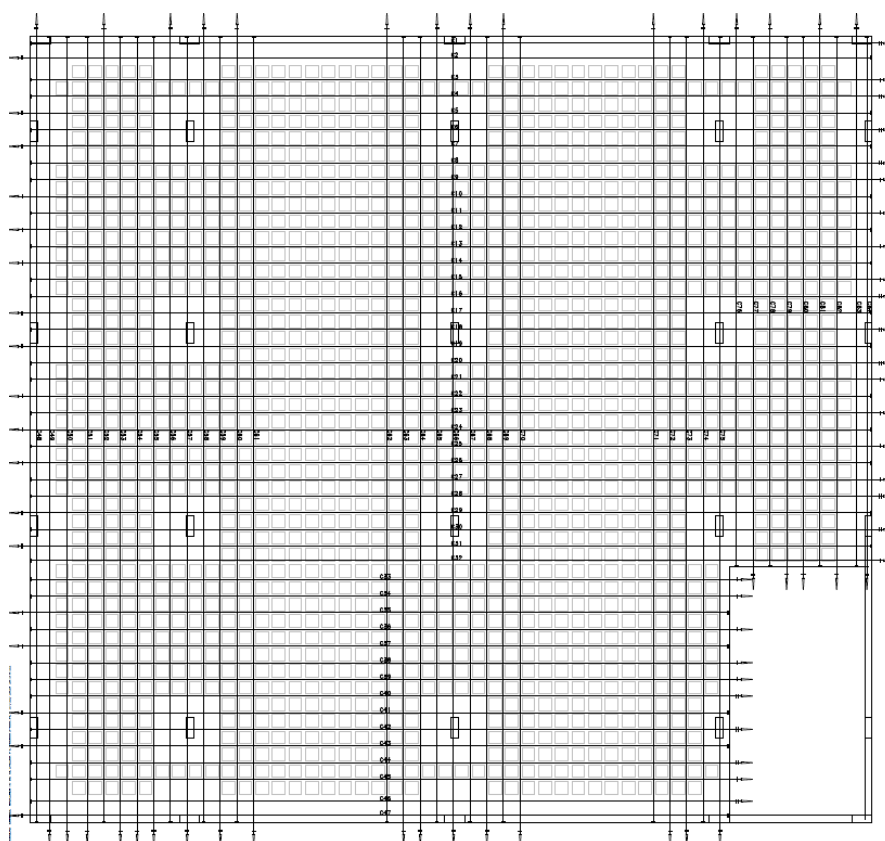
Projeto B2 – Distribuição das cordoalhas de protensão em planta.
